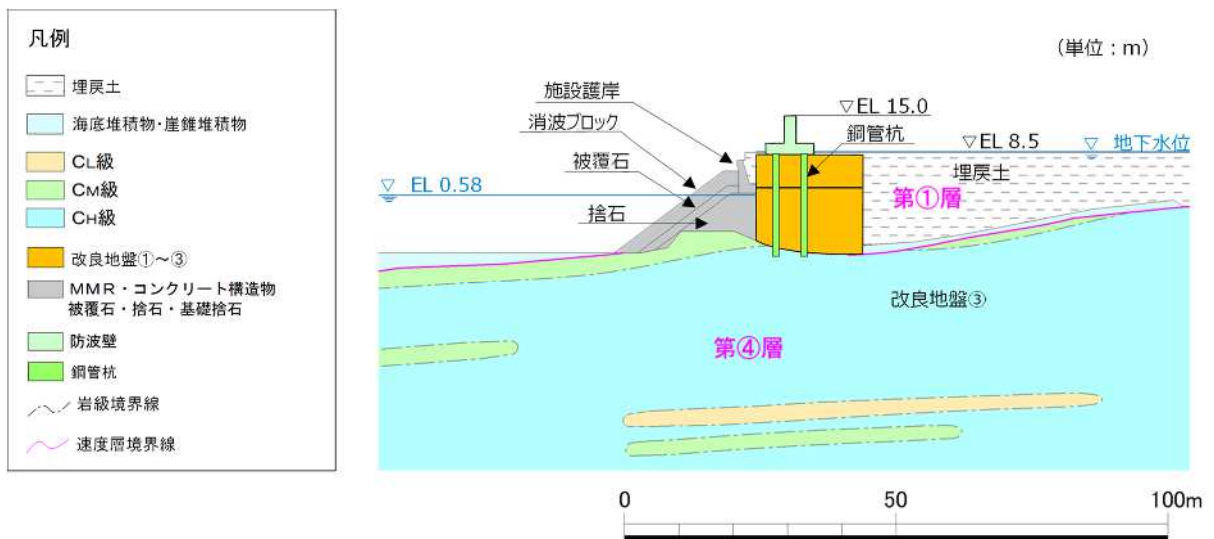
鋼管杭影響検討断面図（⑤-⑤断面）
